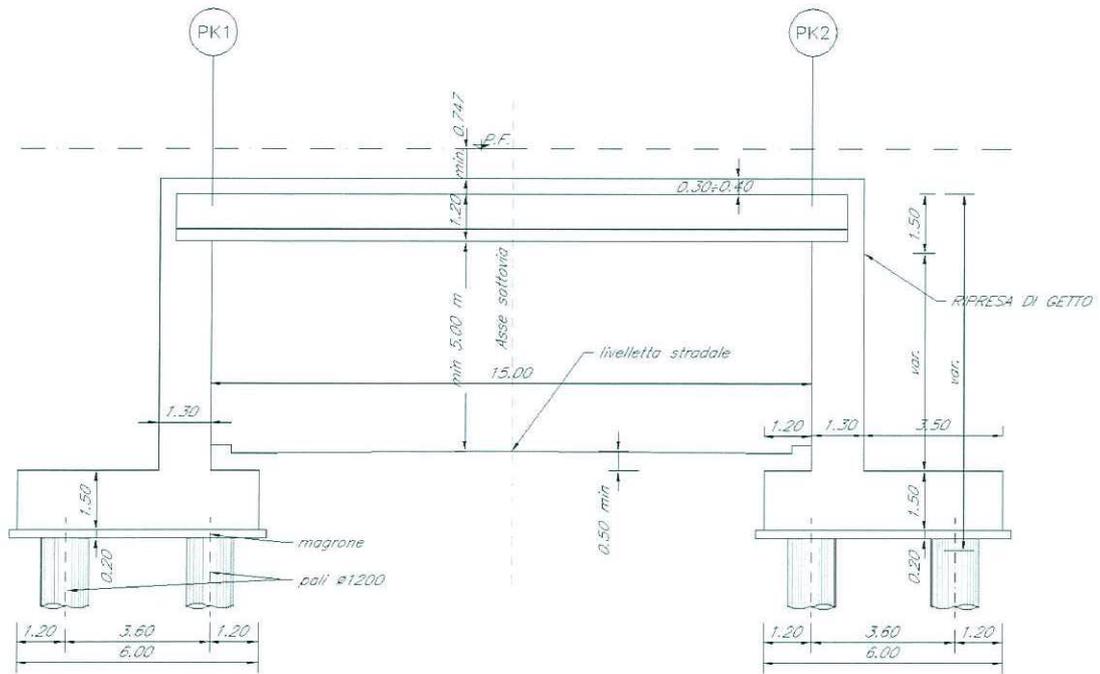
Prospetto in corrispondenza di attraversamento stradale.
